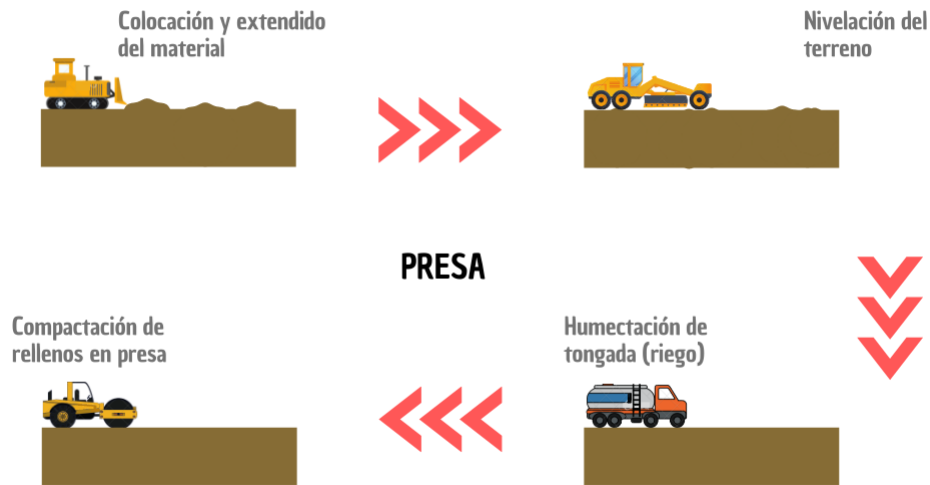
Secuencia constructiva para la construcción de rellenos. *Fuente:* Elaboración propia
